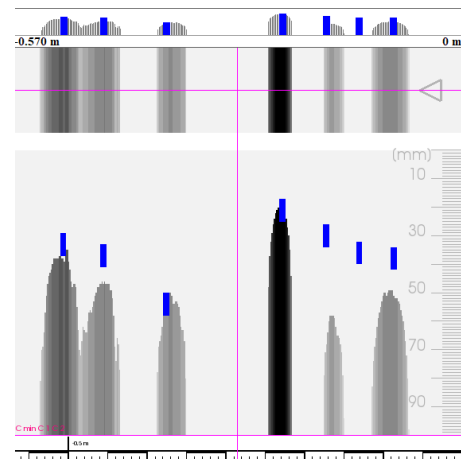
Poutre Pt05 – Travée 3 à mi-travée
